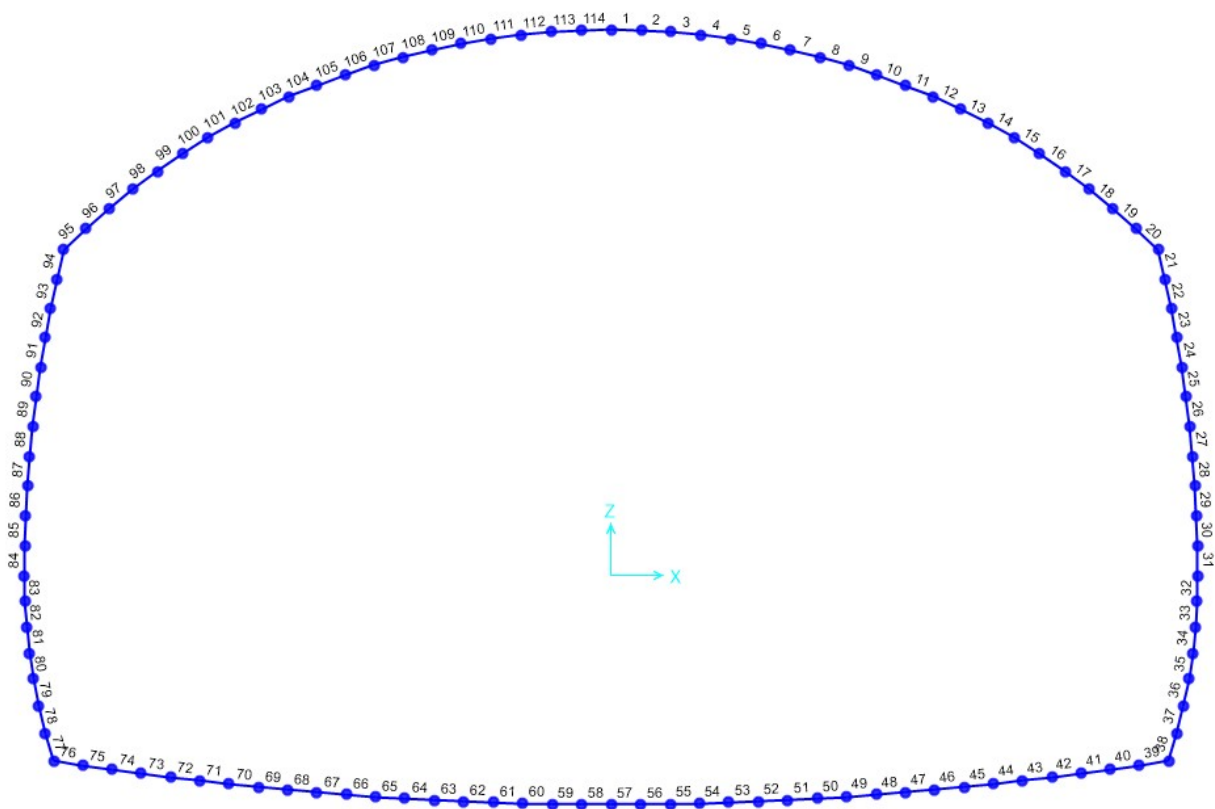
Sezione GA-C2-Imb: modello sezione trasversale
